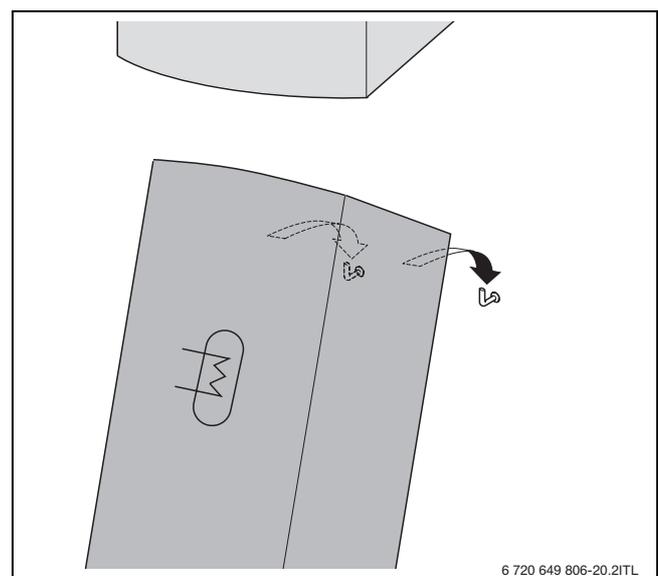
Montaggio dell'accumulatore-produttore di acqua calda
